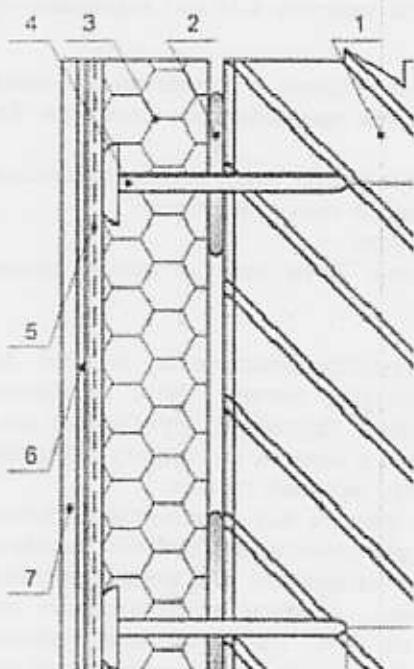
Фрагмент конструкции скреплённой наружной теплоизоляции
